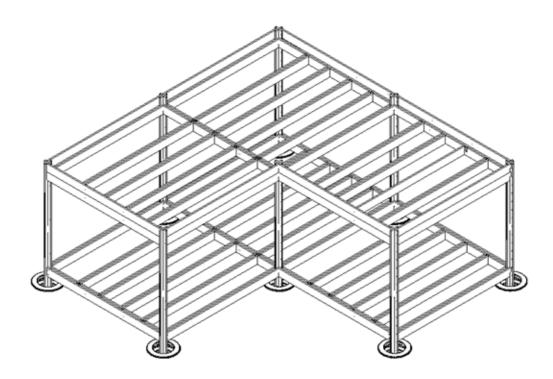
Instalación de vigas secundarias. FUENTE: Autoría propia.
